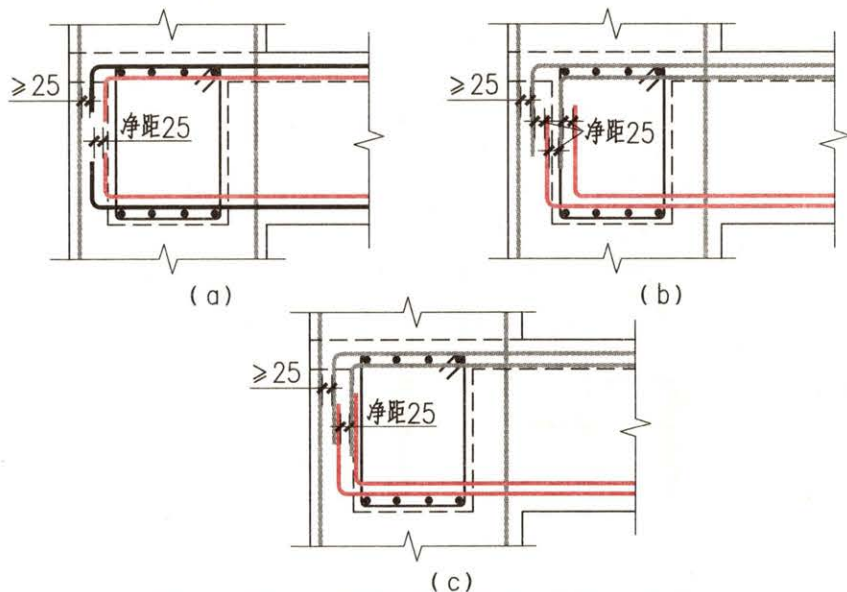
梁纵向钢筋支座处弯折锚固构造详图
